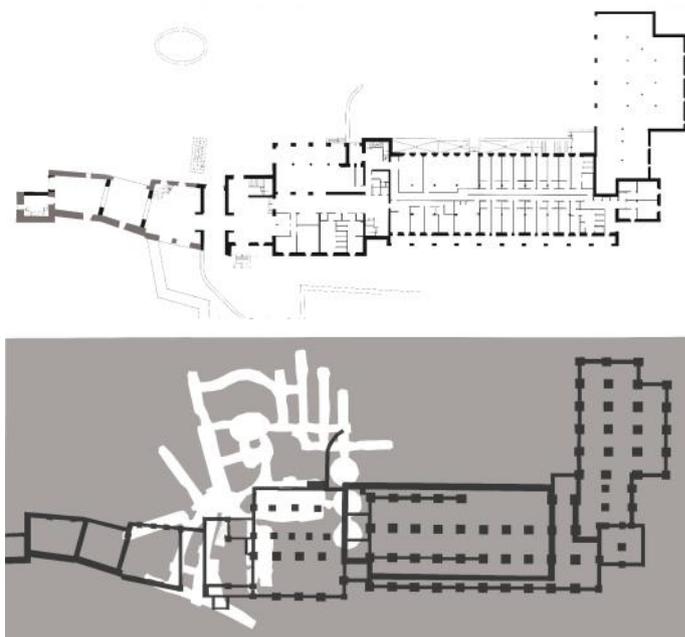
Elaboración de la autora a partir de los planos de Ignacio Gárate. Planta baja: proyecto de parador nacional (...) [AITE]; Planta sótano: proyecto de consolidación de terrenos y construcción de muro de contención (...), 1973 [CADA]
